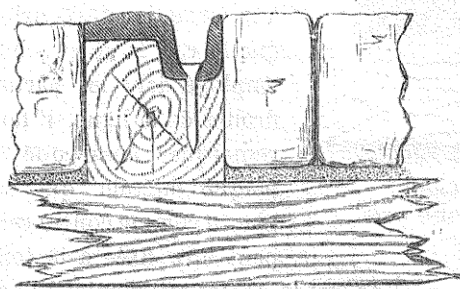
Tramways du port de Belfast, Système Salomond. Rail de 35 kil. par mètre courant. Échelle 1/8.
